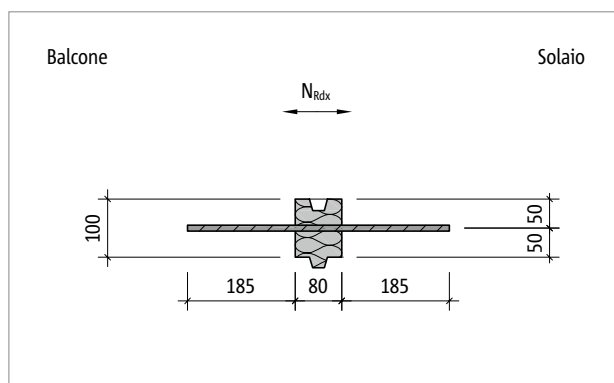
Schöck Isokorb® T tipo HP-NN1: pianta del prodotto
